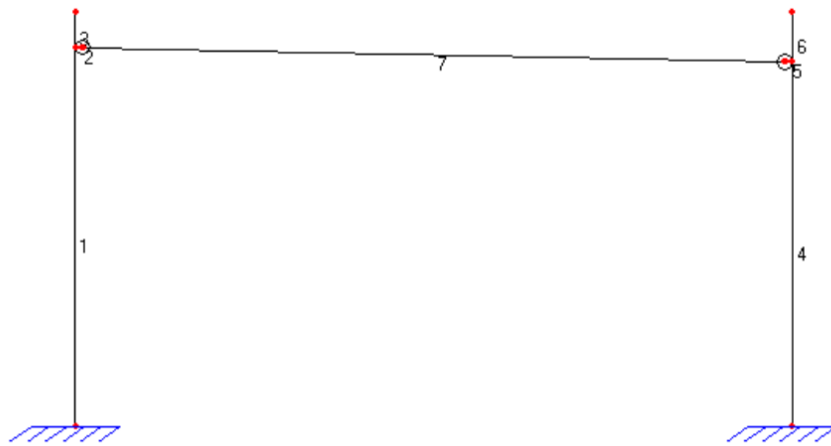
Ejemplo del esquema de barras de uno de los pórticos estructurales.
